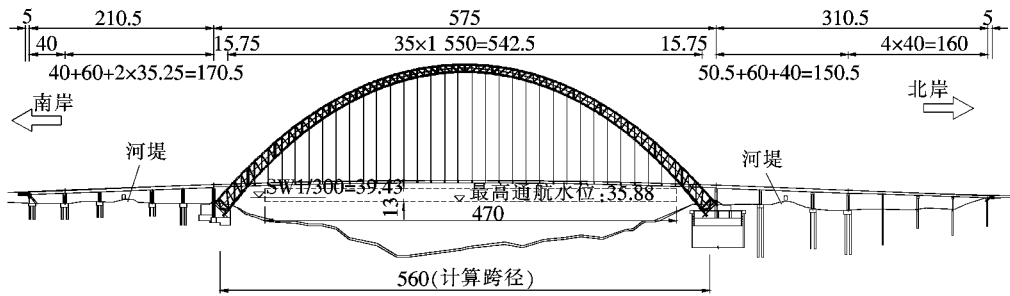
钢管混凝土拱桥方案立面布置图(单位:m)
